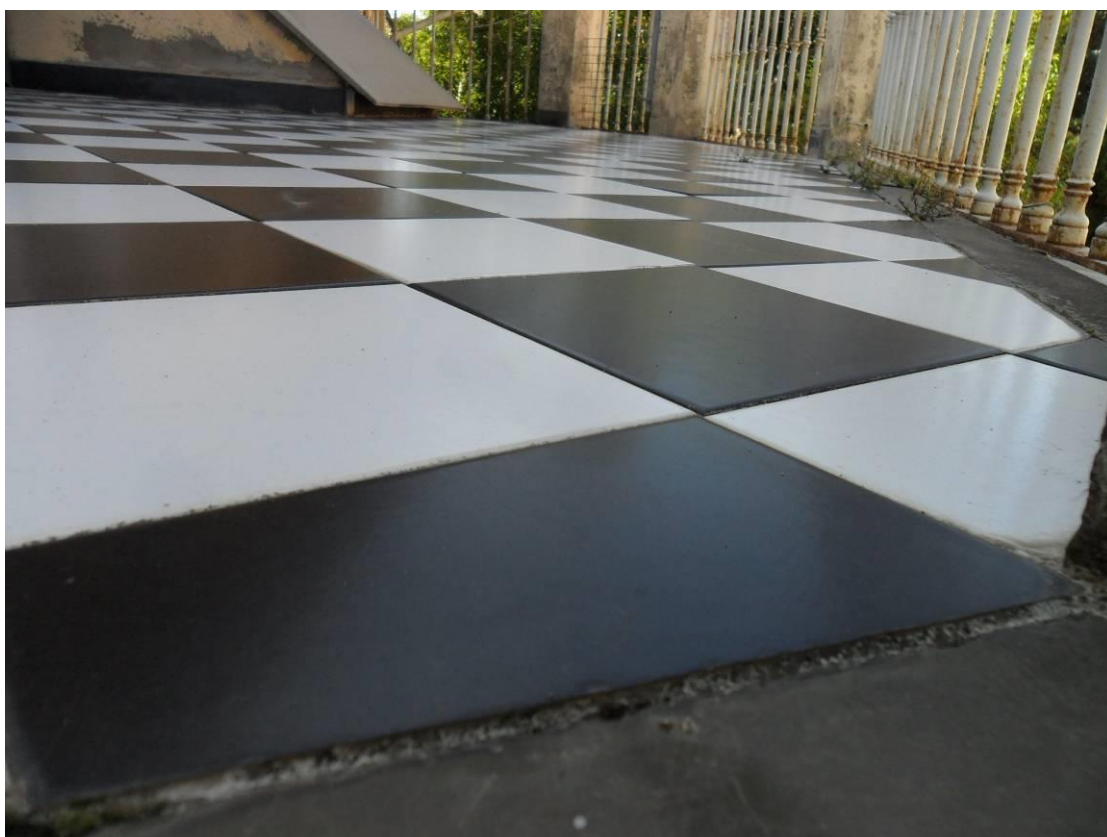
Dettaglio della pavimentazione a terrazzo praticabile del corpo emergente
